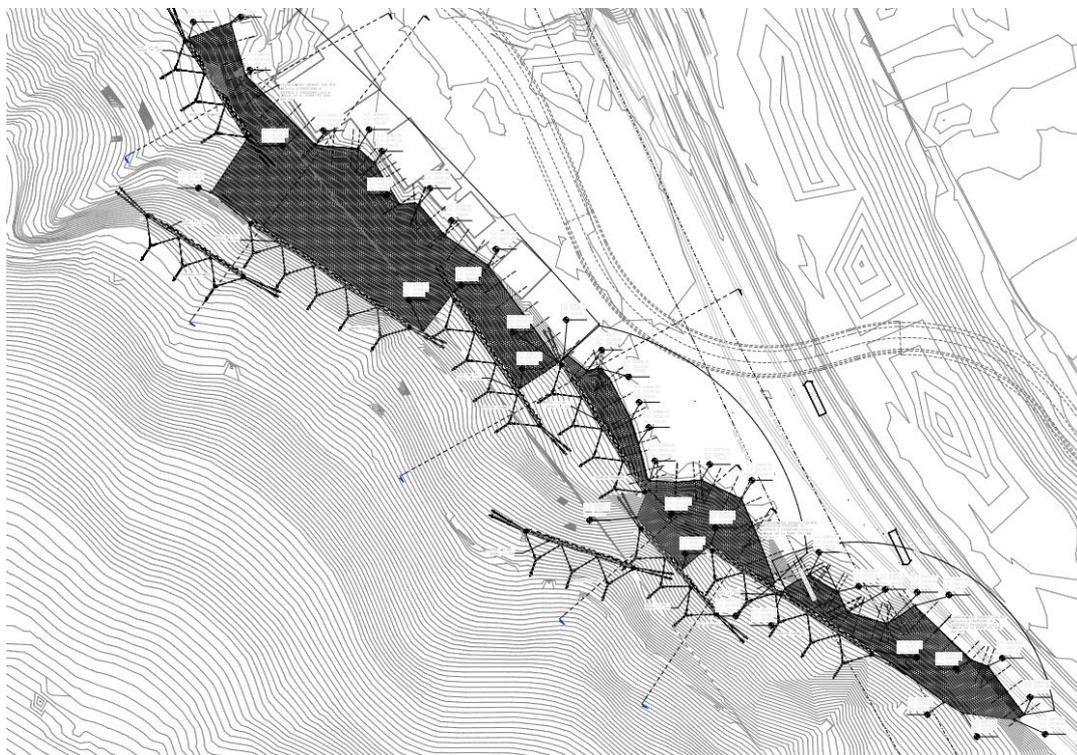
Imbocco Nord Scaleres – Barriere paramassi e reti di protezione del versante - localizzazione degli interventi
